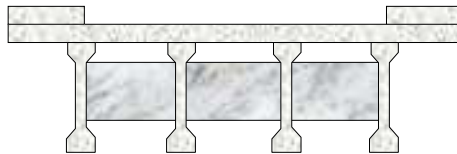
Losa maciza sobre vigas “I” de hormigón pretensado
